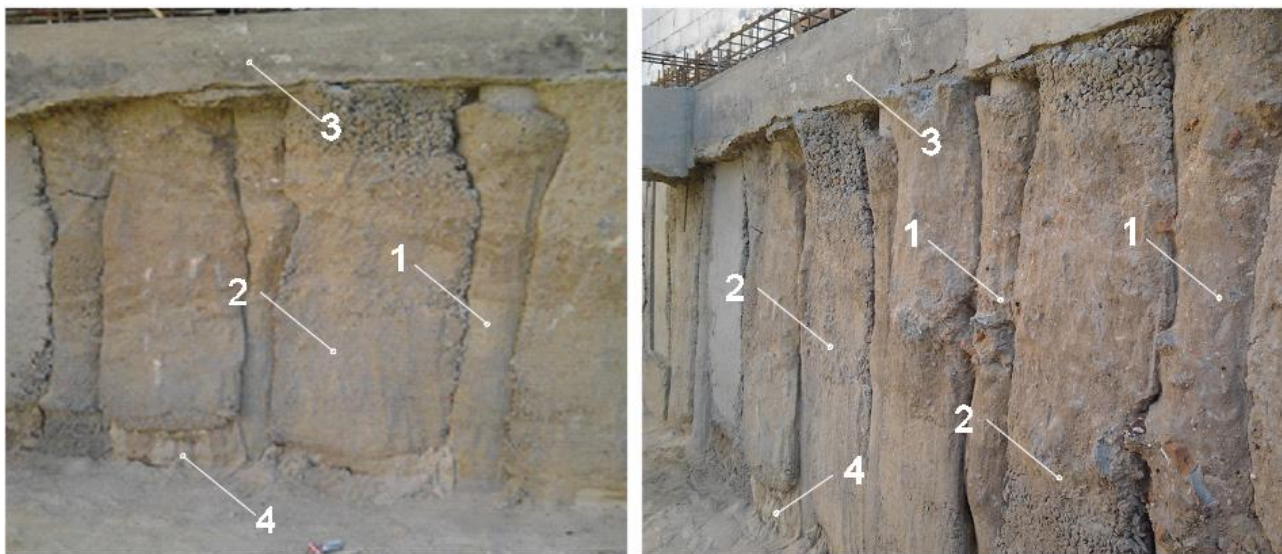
Реалізація пропонованої технології (загальний вигляд монолітної шпунтової бетонної підпірної стінки): 1 – буронабивна залізобетонна паля; 2 – міжпальовий простір заповнений бетоном; 3 – монолітна залізобетонна балка обв'язки; 4 – недобір ґрунту
